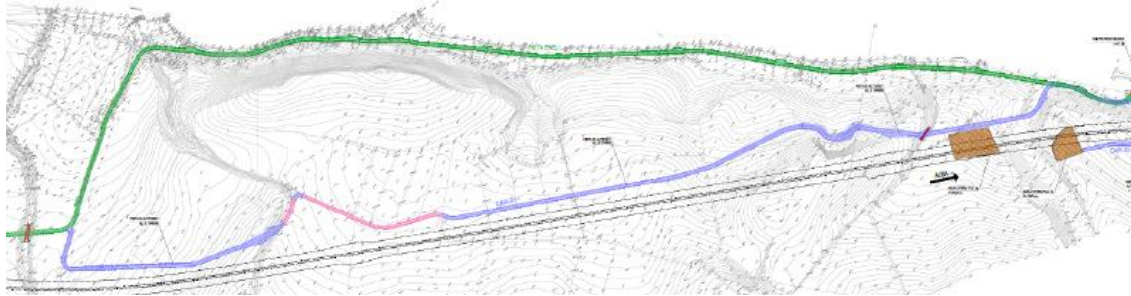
Pista interna CAN01(rosa, viola) e Pista Enel (verde)
